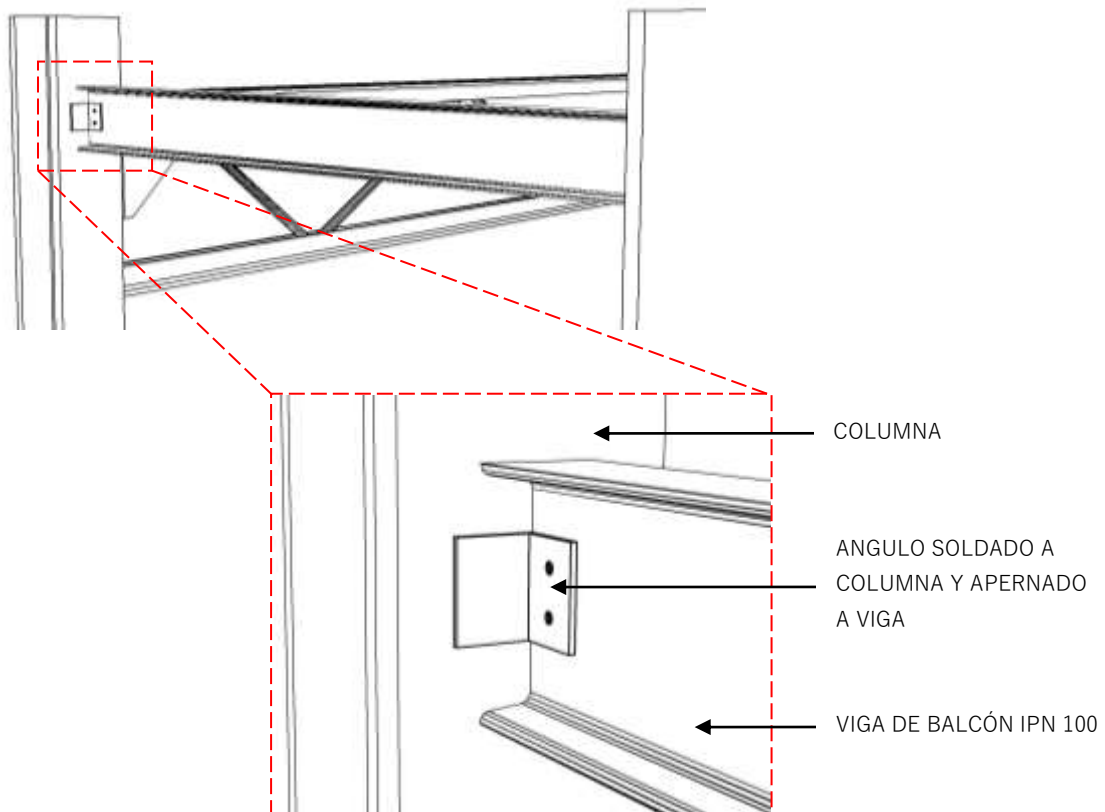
Detalle de plancha de sujeción en Viga de Balcón
